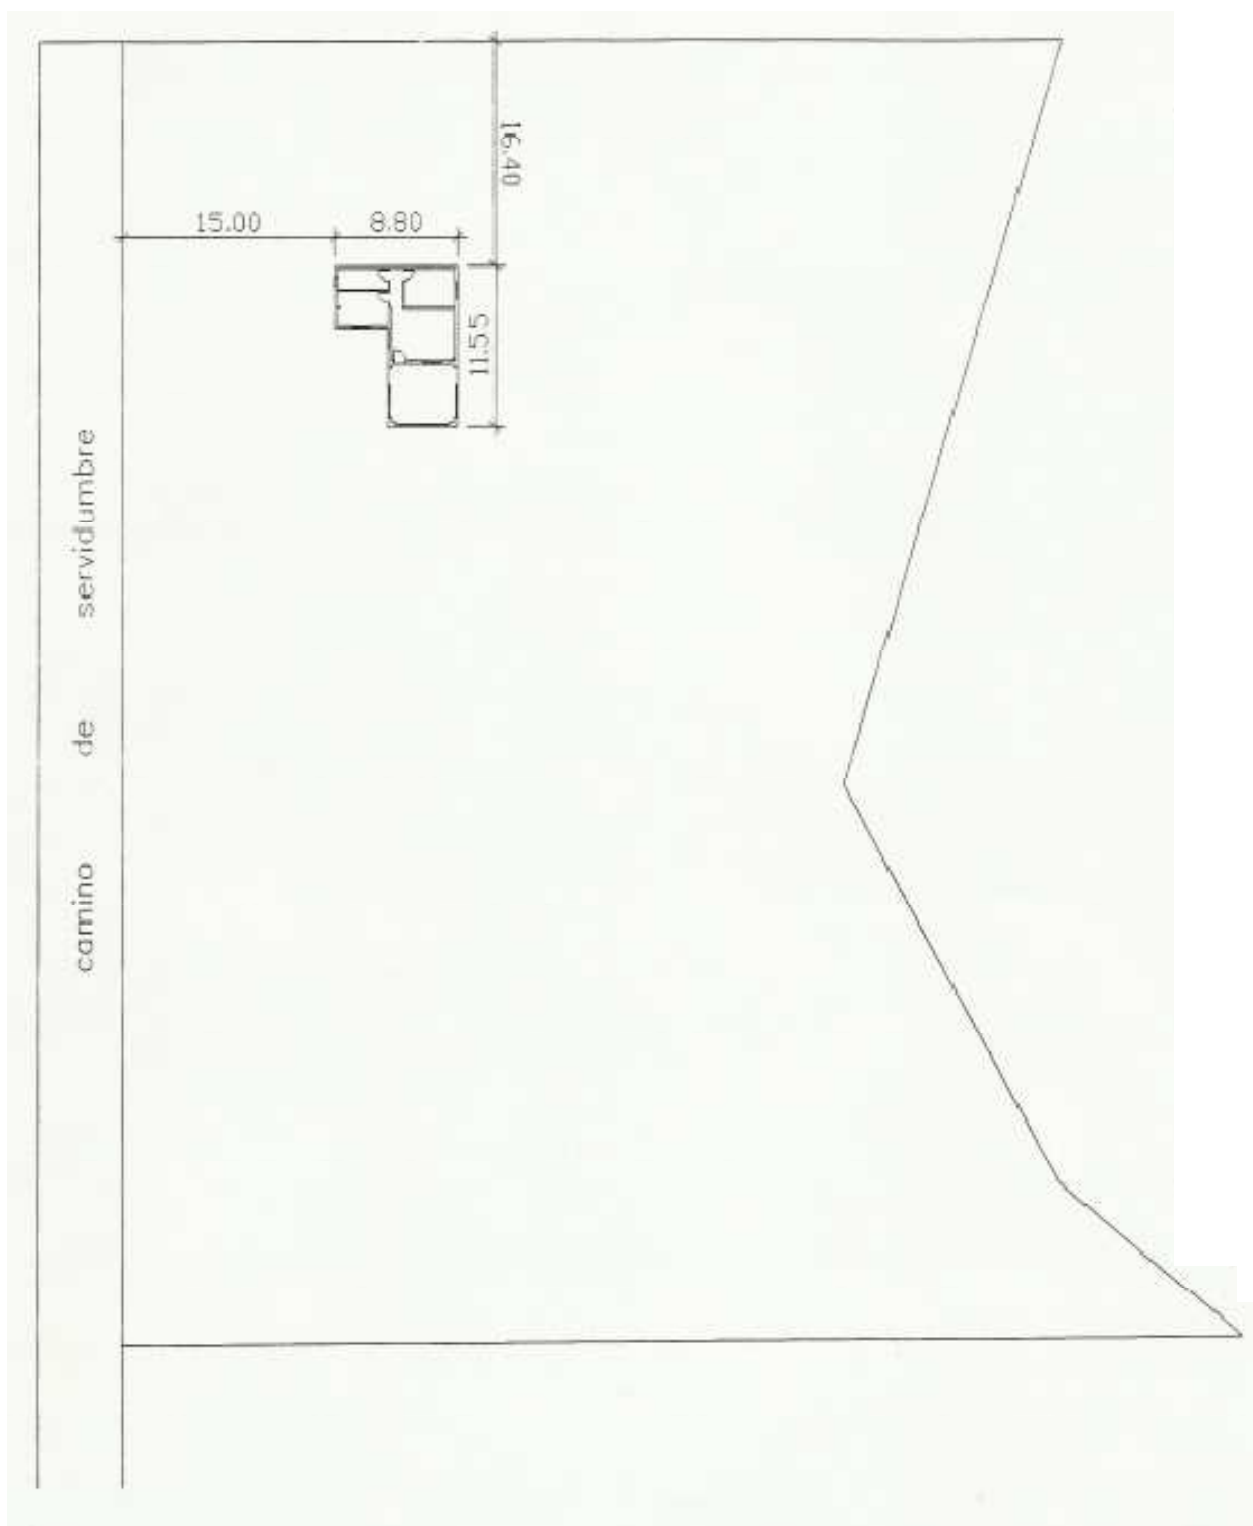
a) Plano nº 5.a): Vivienda unifamiliar rural aislada. Plano de emplazamiento
